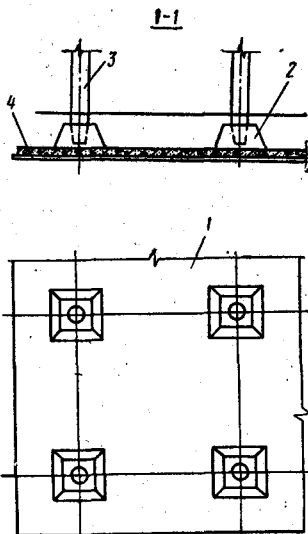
Железобетонная безбалочная фундаментная плита:
